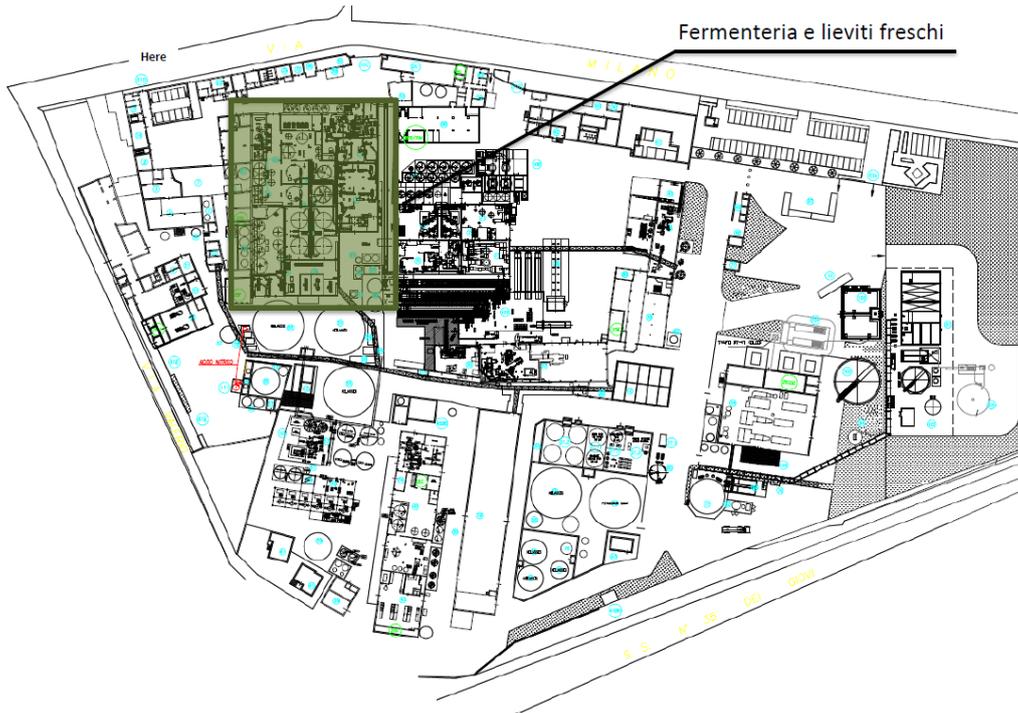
Planimetria – Reparto fermenteria e produzione lieviti freschi.
